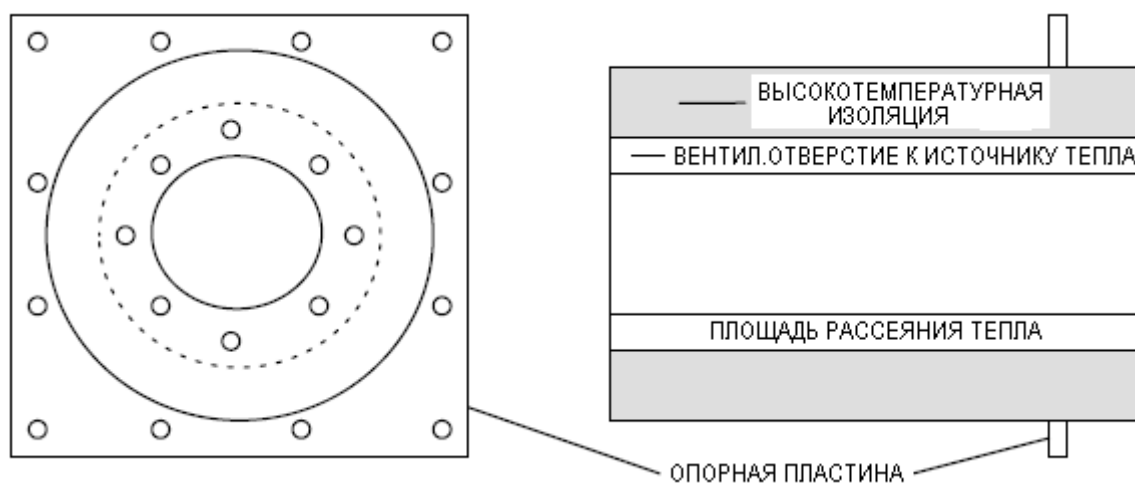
Типовая конструкция пожарозащитной муфты для установок с возгораемыми стенами.
